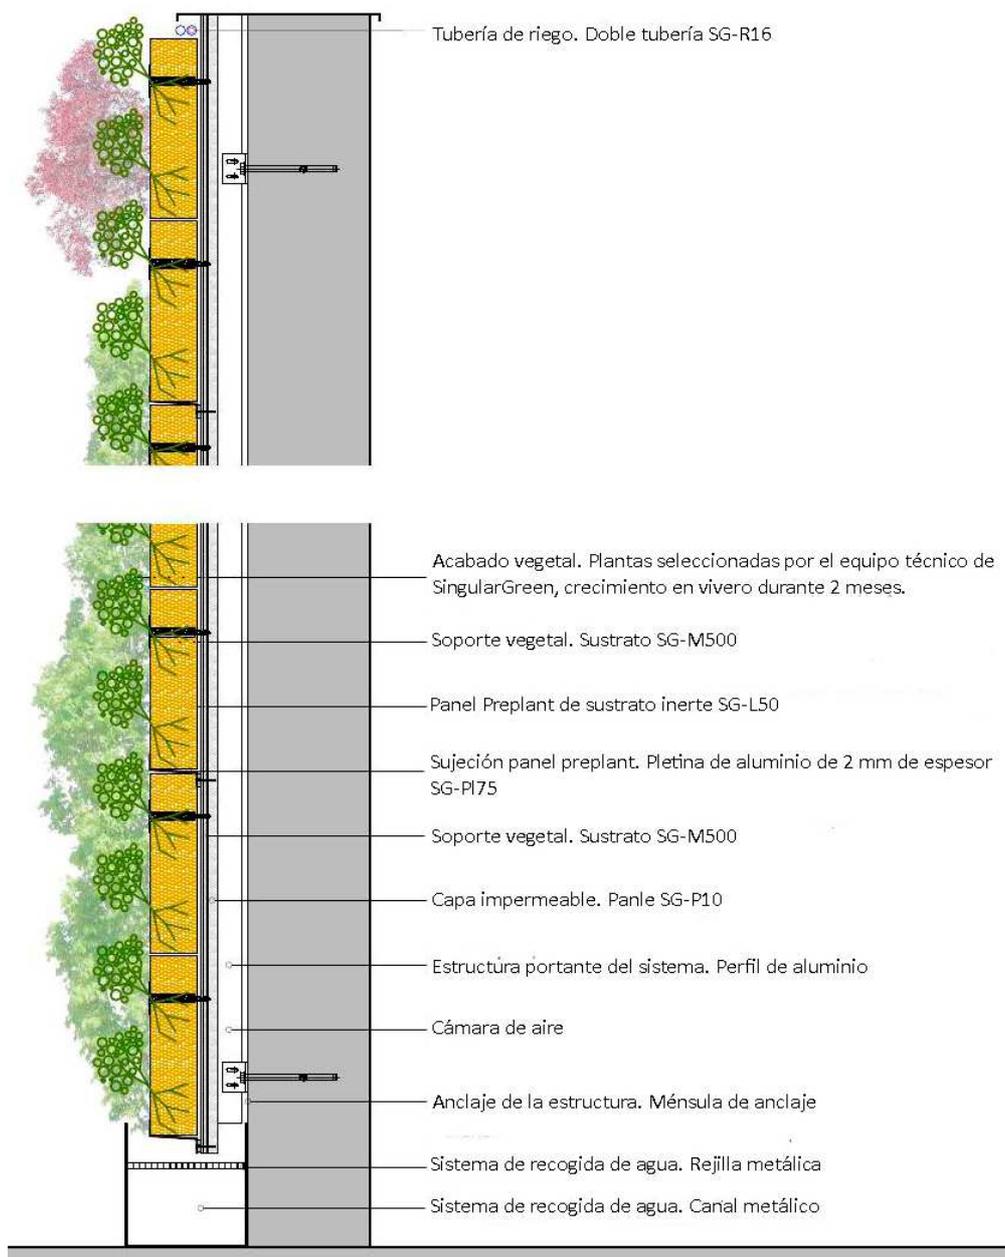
Detalle constructivo de la solución F+P Preplant [2]
